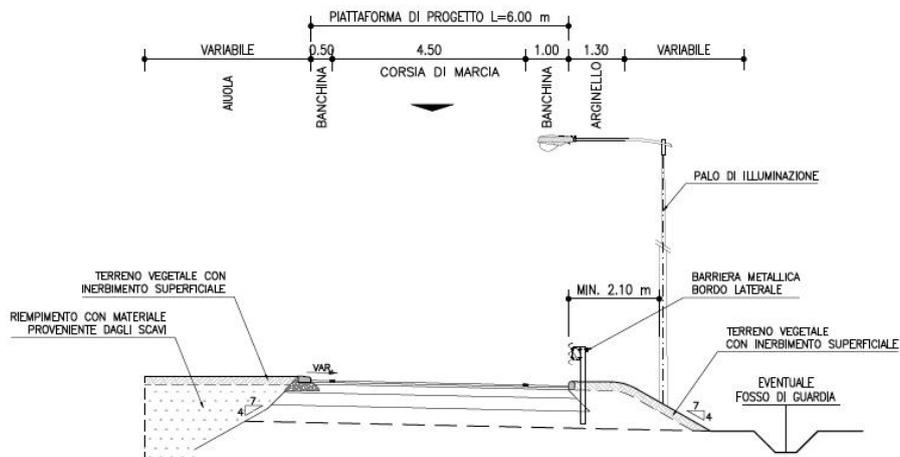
Sezione Tipo ramo di uscita dalla rotondella
